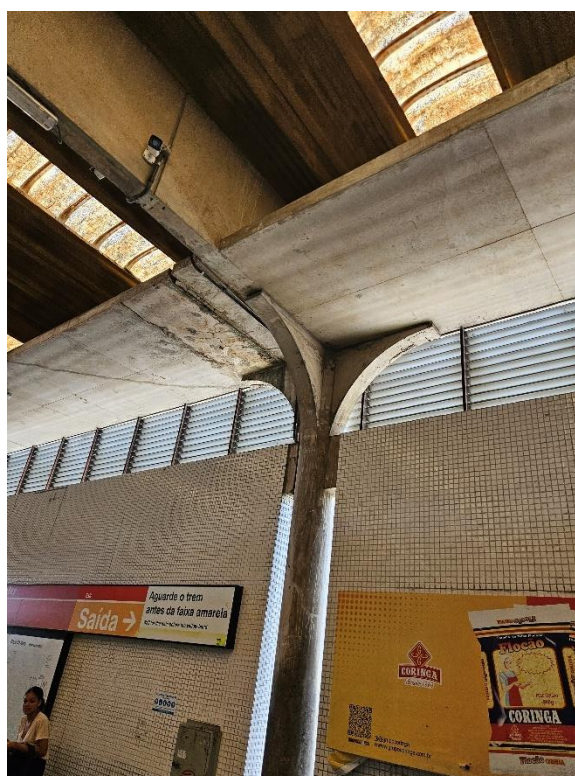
Plataforma da Estação – Infiltrações e Ferragens Expostas
